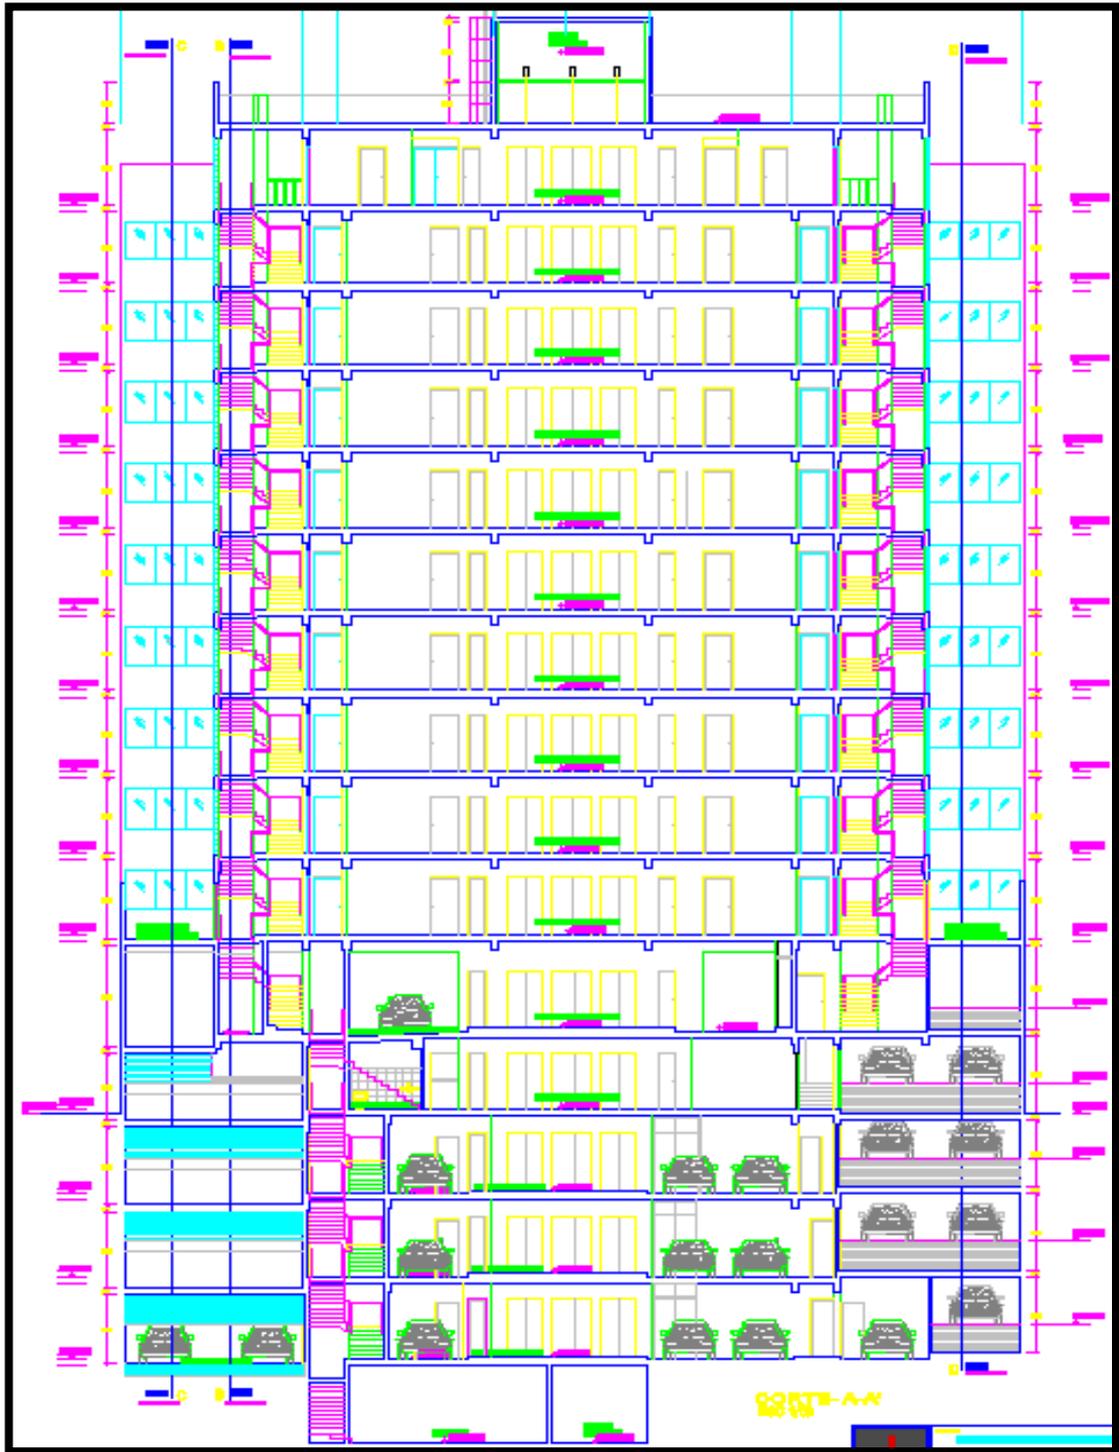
Plano de Corte A-A'- Transversal a Edificio Monte Rosa
